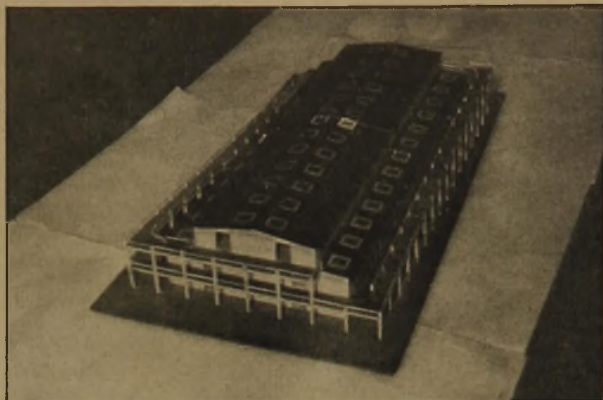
Modell des ursprüngl. Entwurfs mit offenen Rampen-Umfahrten.
